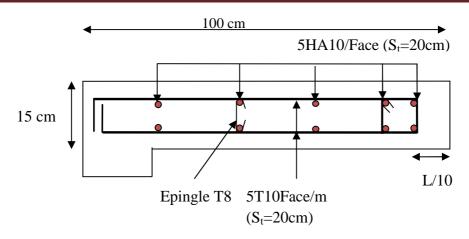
Schéma de ferraillage du voile Vx1 des niveaux 4 à 9
